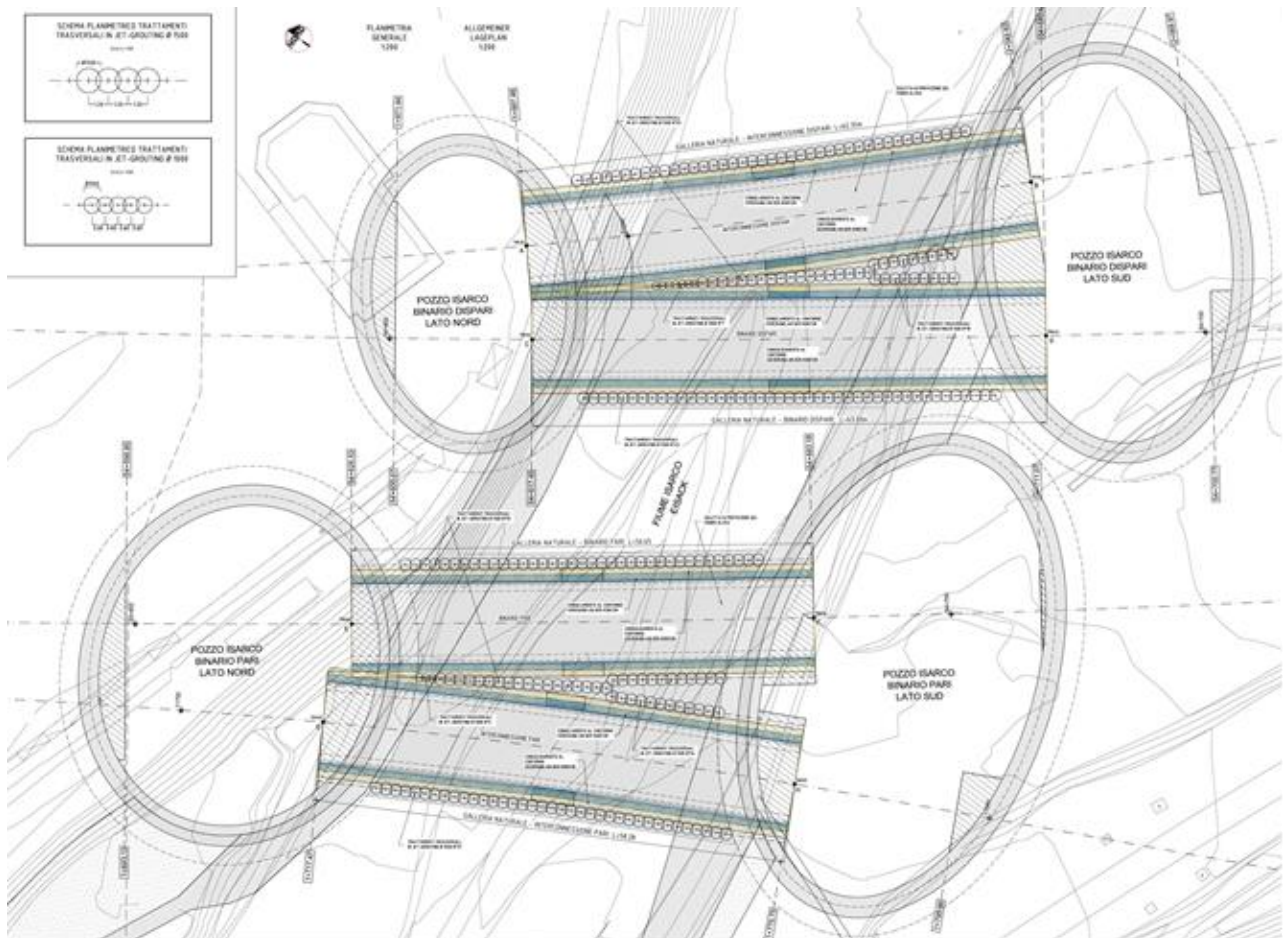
Allgemeine Planimetrie der Eisack-Unterquerung mit den querliegenden Scheidewänden in Jet
